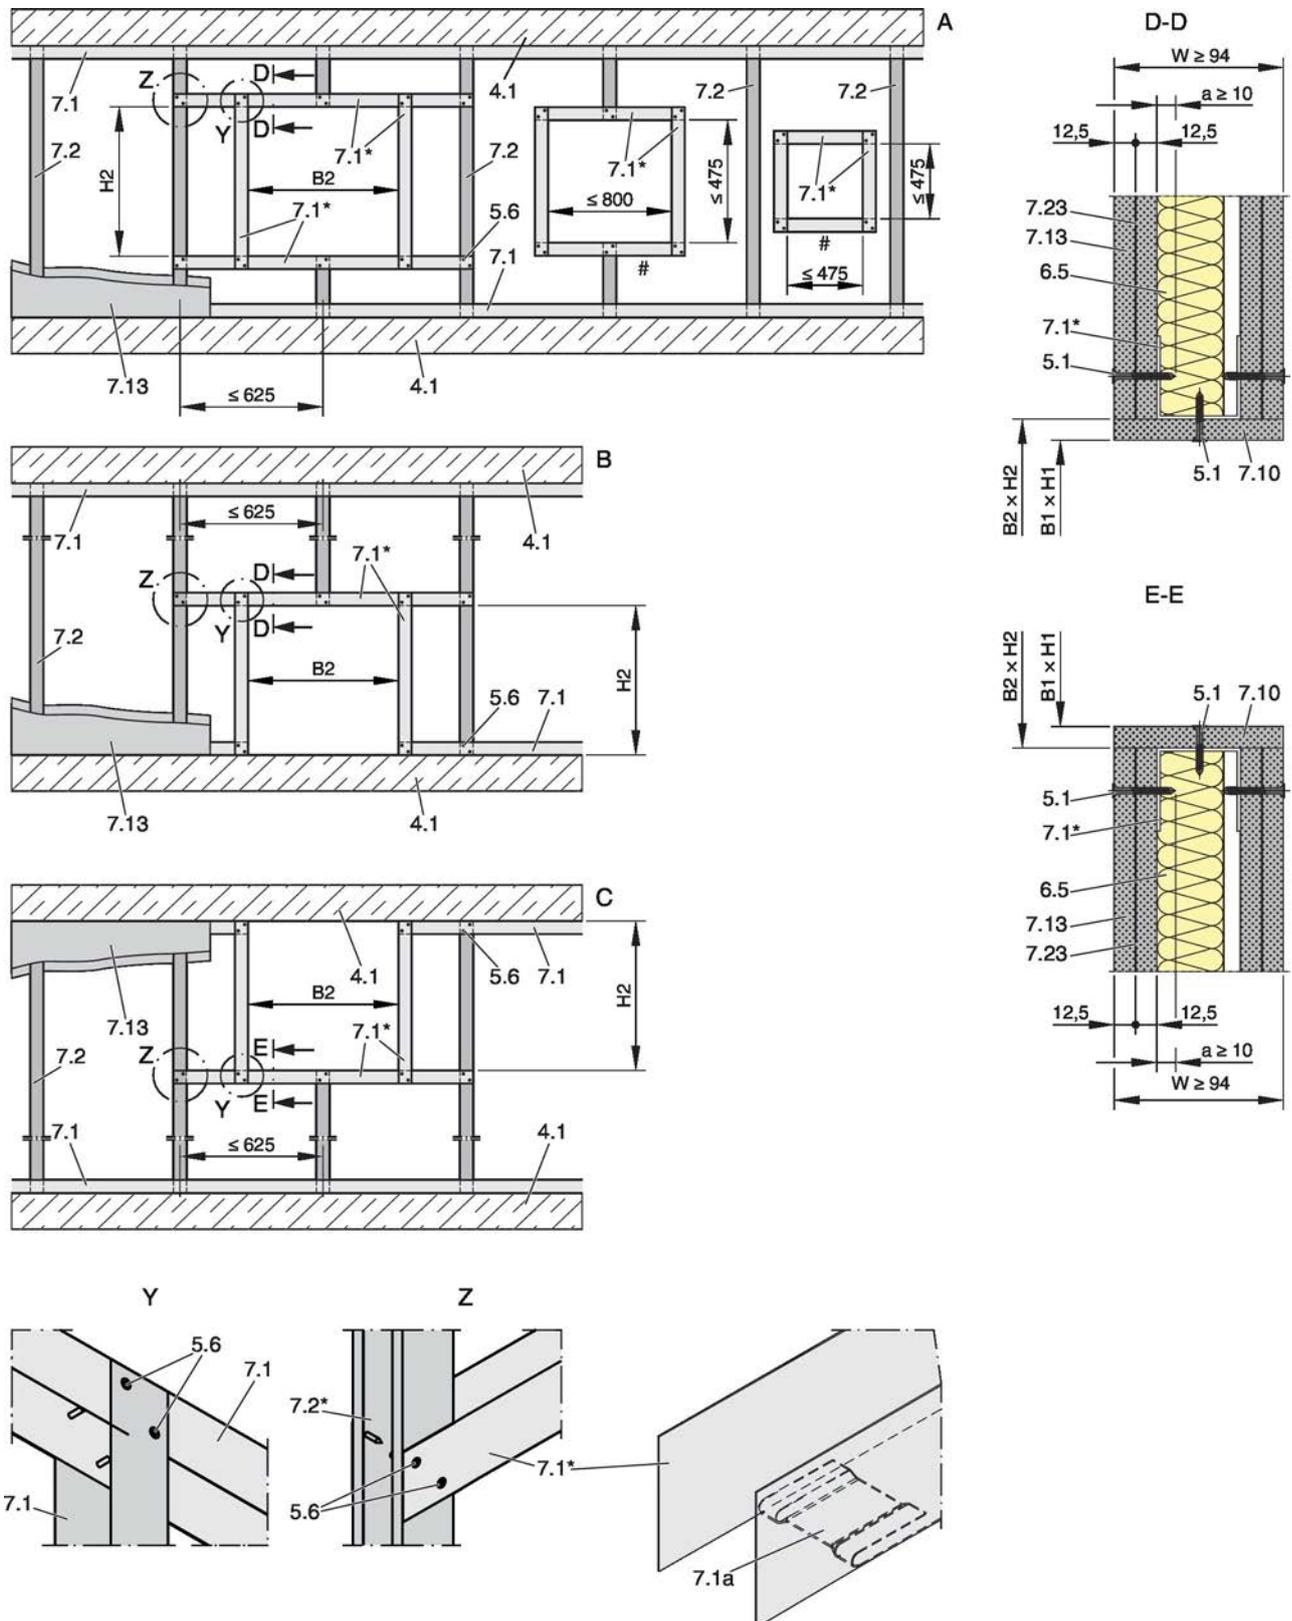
Tabiques divisorios ligeros con estructura de soporte metálica y revestimiento por un lado
